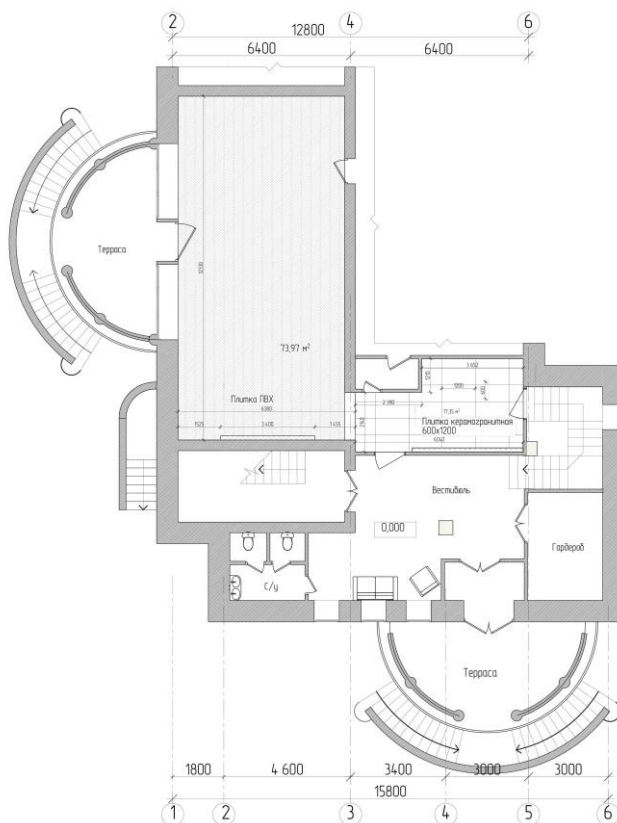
План пола фрагмента 1 – го этажа (ресторан и бар)
